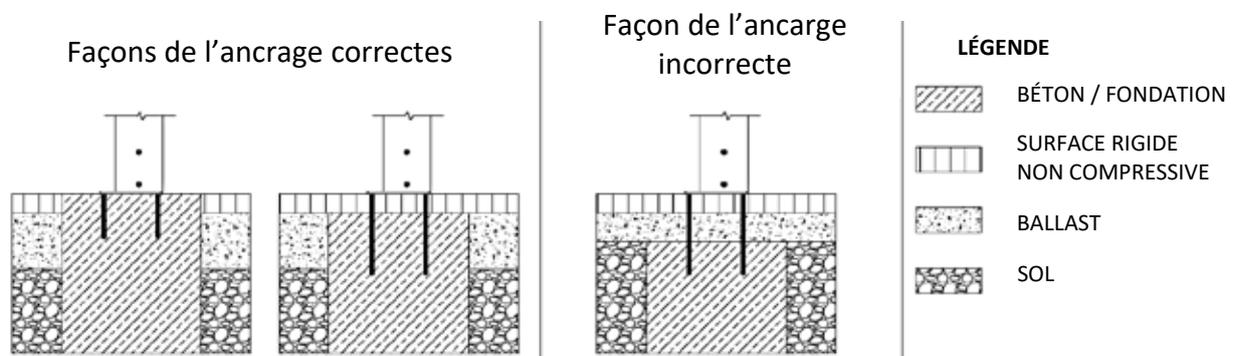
Fundament Instructions d'ancrage de la structure porteuse de la Pergola SB500. Fondation
